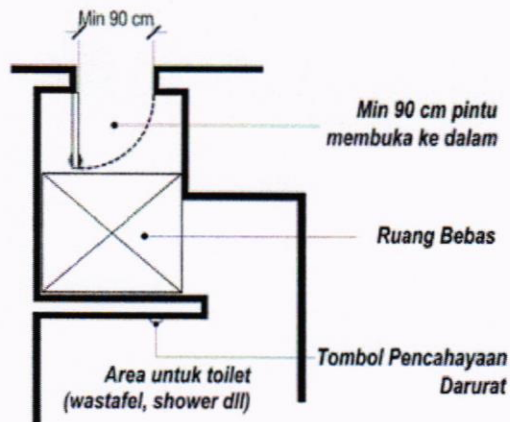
47 Analisa Ruang Gerak Pada Ruang Toilet (Pendekatan Samping) [2]
